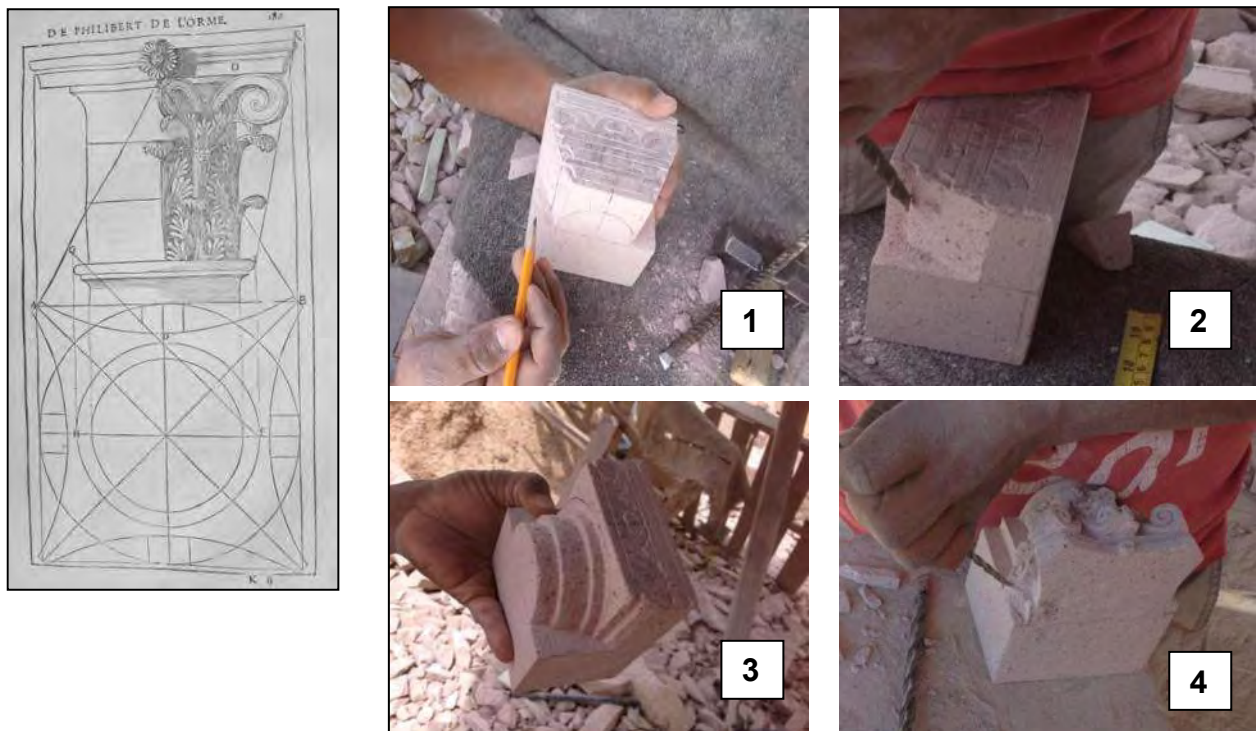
a.- Imagen superior; de planta y alzado de un capitel corintio, por Philibert de L'Orme. *Architecture*. 1626.
